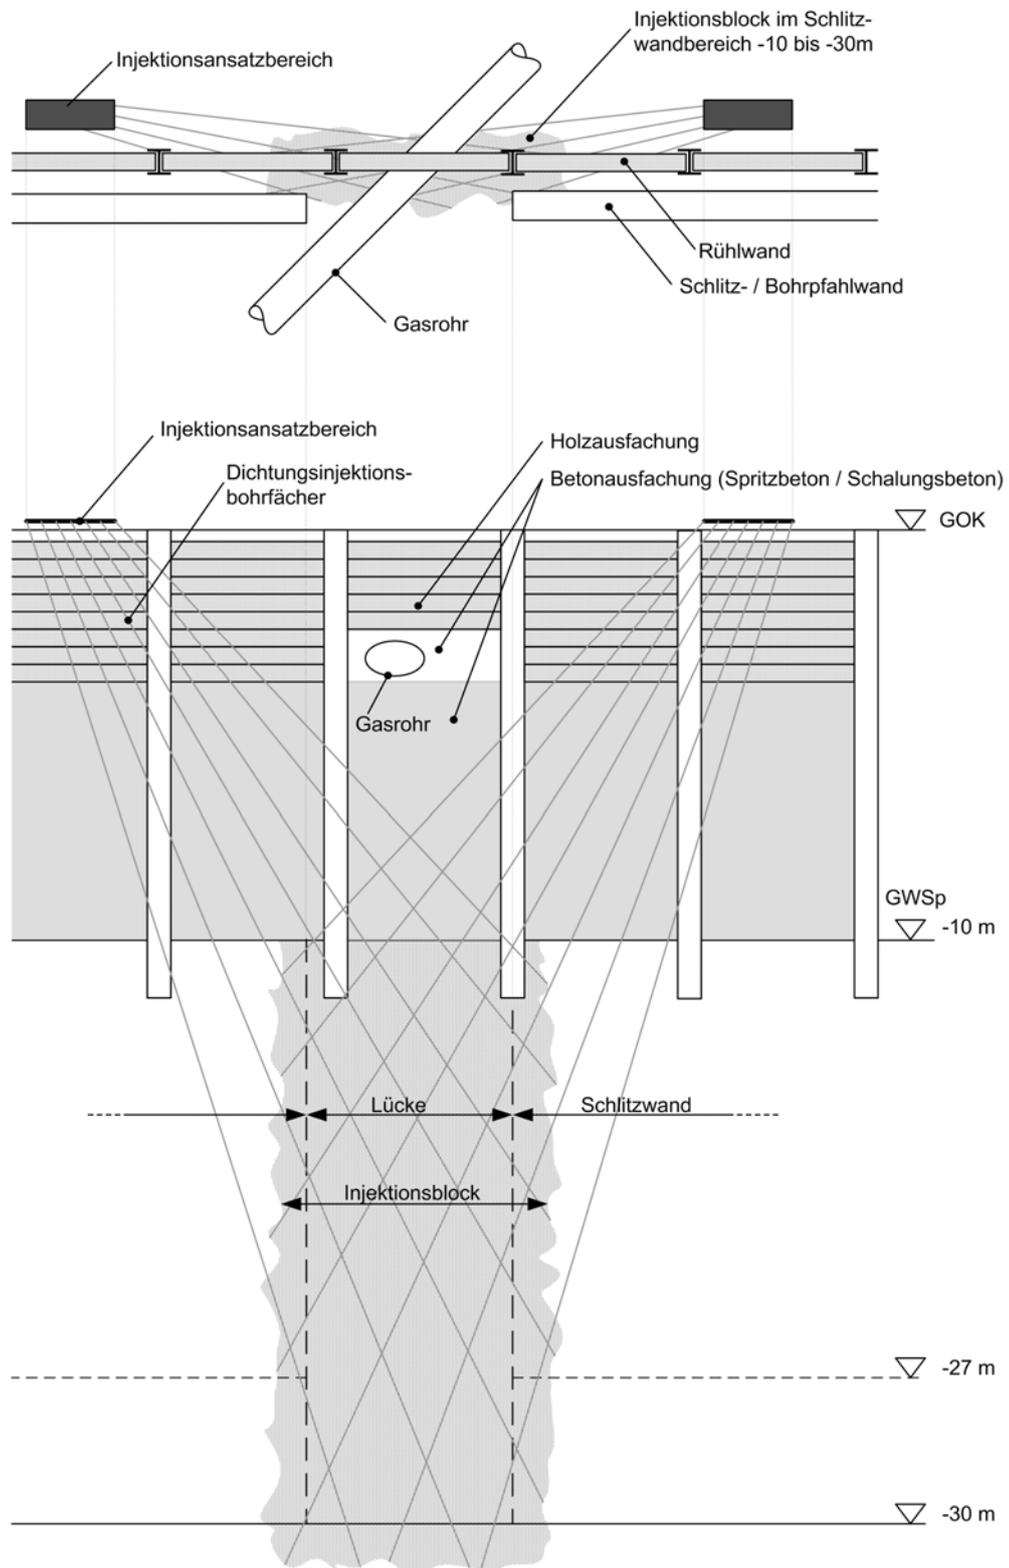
Grundriss und Schnitt des Injektionsblocks
